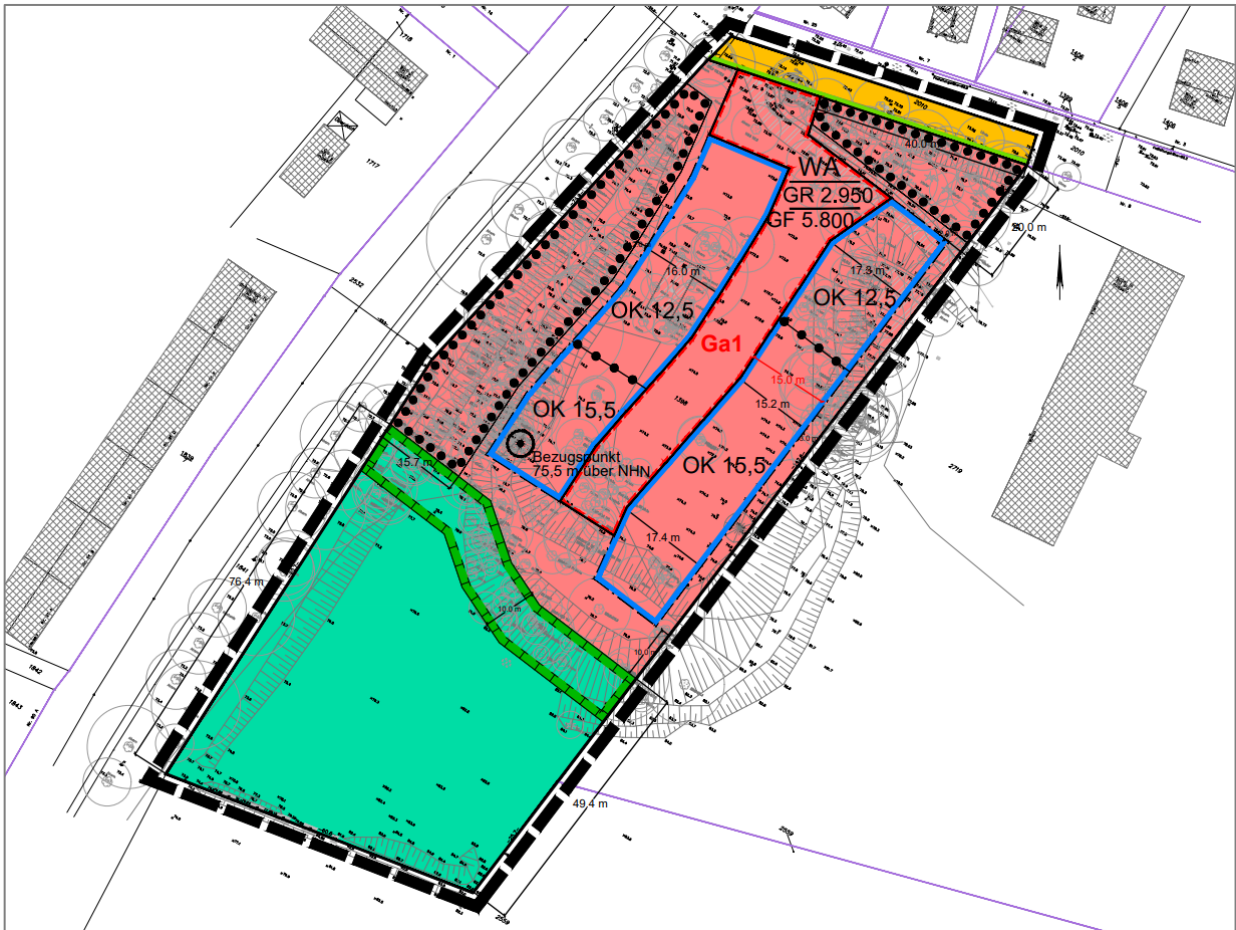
Auszug Bebauungsplan Nr. 65/20 „Wohnen am Weinberg“ (Stadt Strausberg, 04.08.2021).
